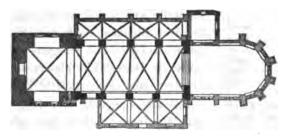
Sagard, Kirche. Grundriss. 1:667.
